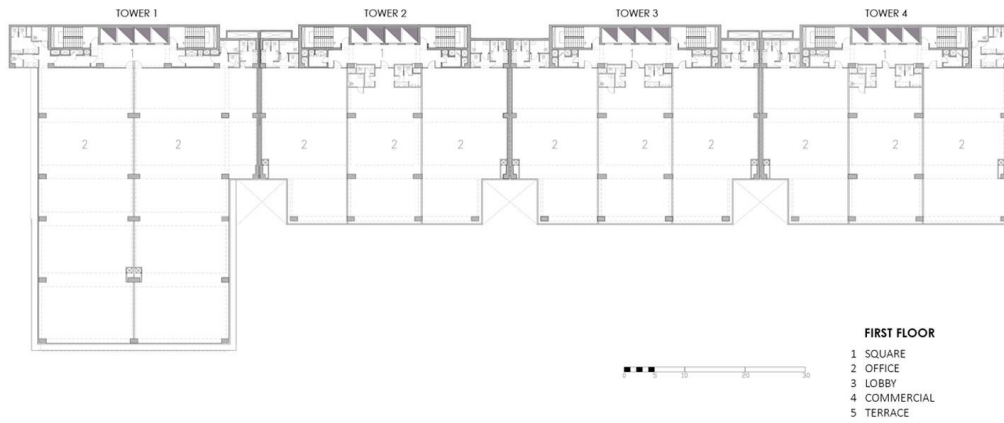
Plano arquitectónico de primer nivel del Centro empresarial Cronos, Santiago de Surco. Recuperado de gonzalesmoix.com
